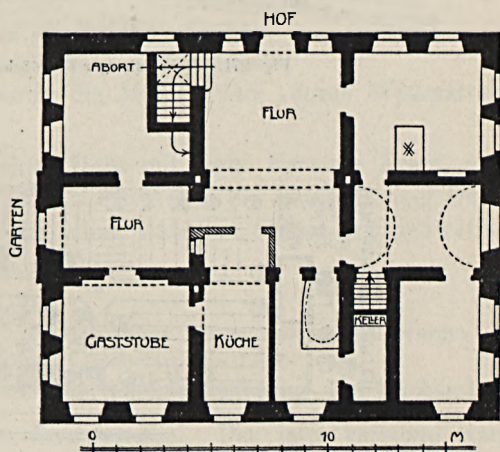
Eckartsberger Schlößchen, Grundriß des Erdgeschosses.
